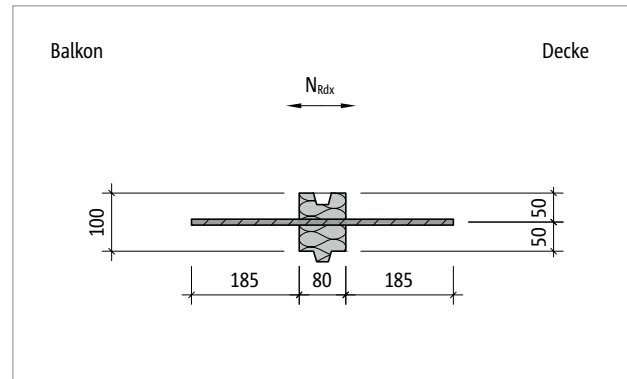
Schöck Isokorb® T Typ HP-NN1: Produktgrundriss
